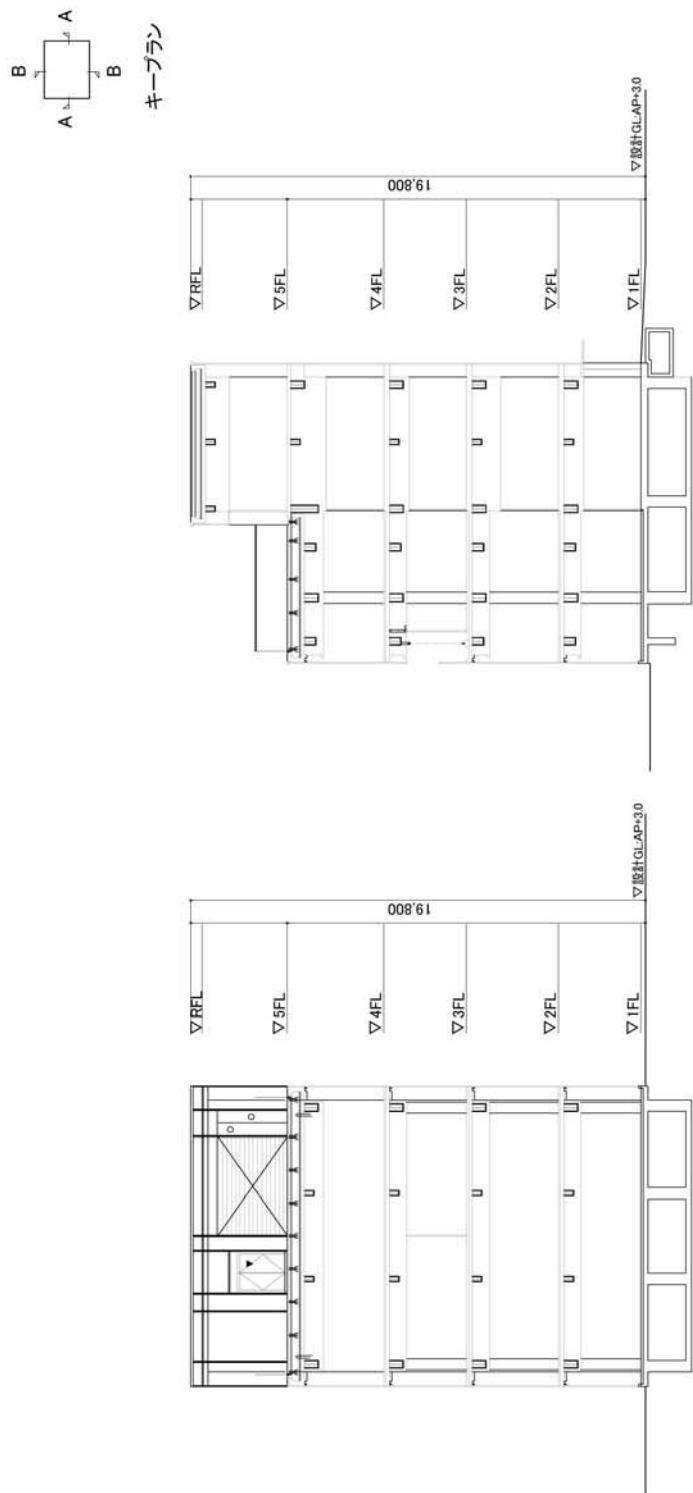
(3) 断面図 (フィニッシュタワー)
